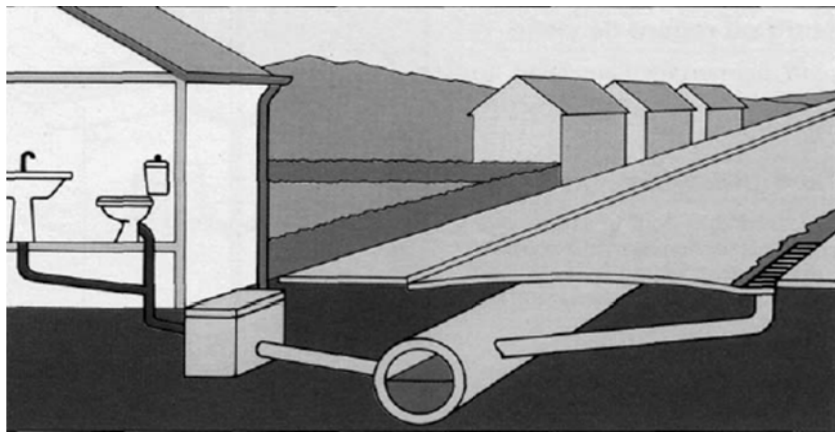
Collecteur unique de transport des eaux usées et pluvial (système unitaire)
